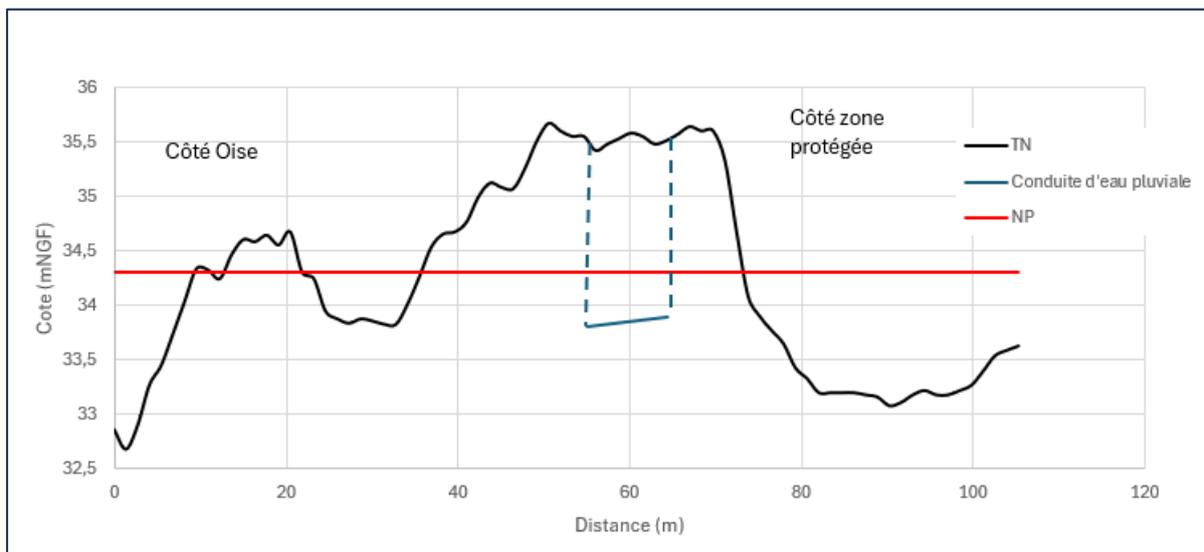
Profils en travers de la RD932 et l'emplacement de la canalisation traversante
